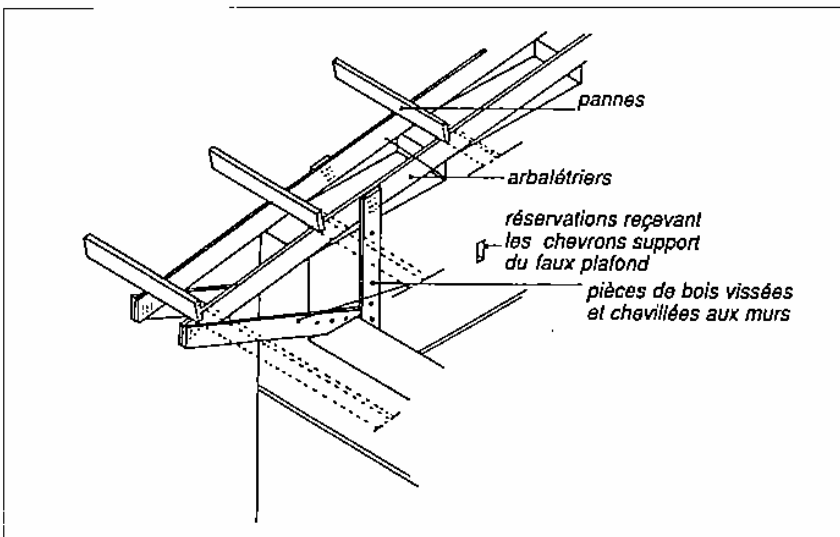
Ferme moisante en mur pignon avec fausses consoles de fixation au mur.
